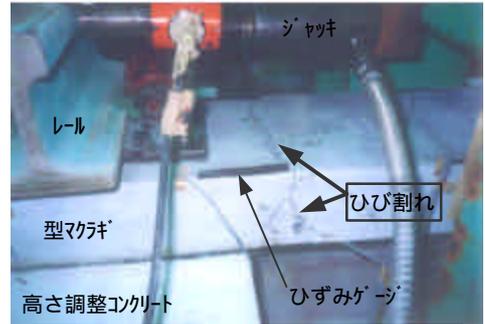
ひび割れ発生状況 (試験体 B)
